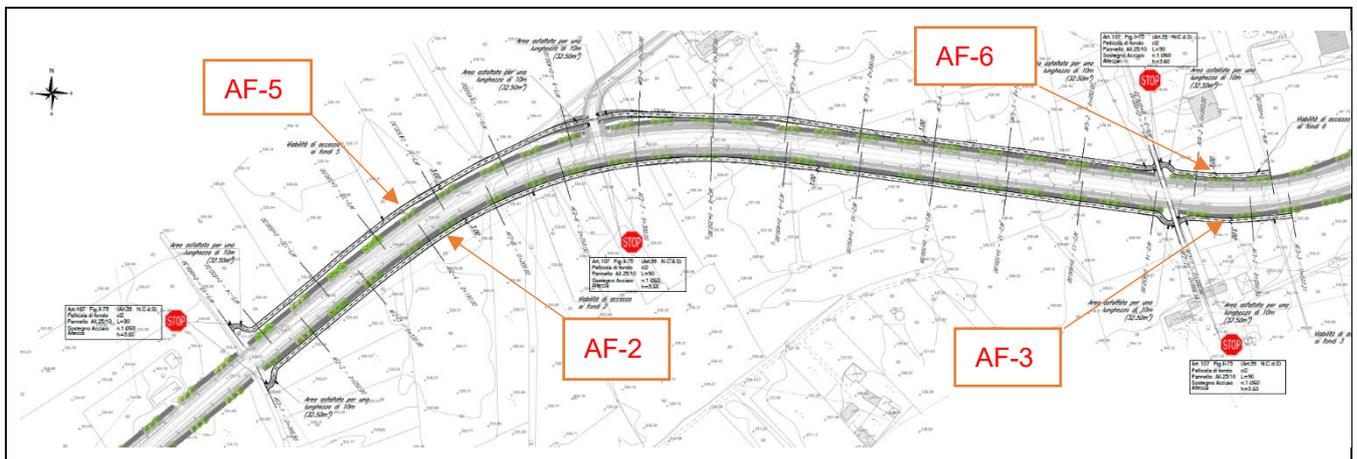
Planimetria delle viabilità di accesso ai fondi – Zona 2 (Nord)
